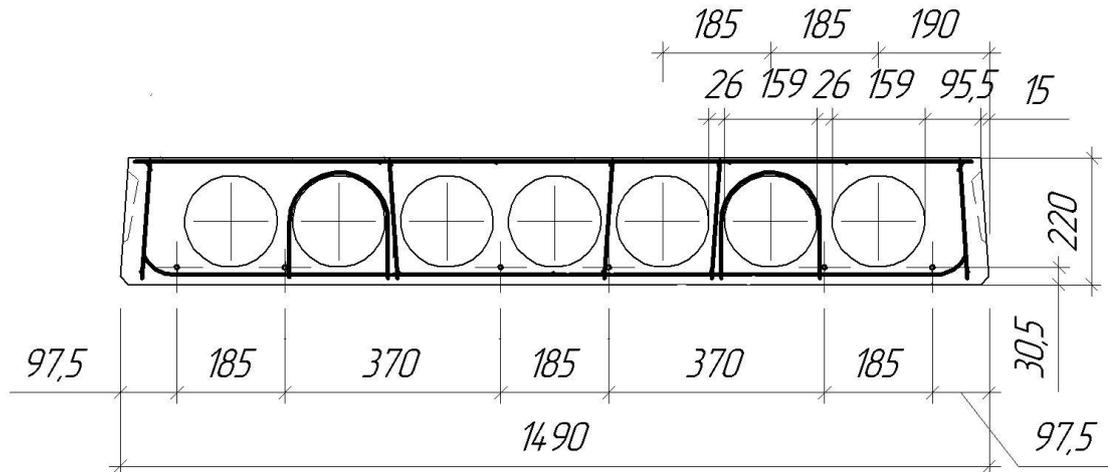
План-схема конструкции сборной железобетонной плиты перекрытия детского ясли-сада
